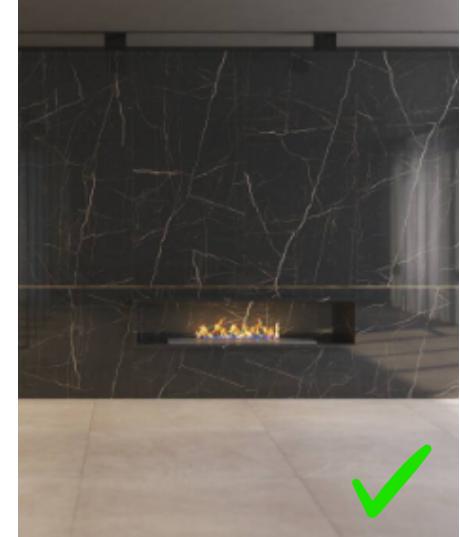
Lareira tipo fire pit com parede externa e nicho interno revestido em porcelanato.
